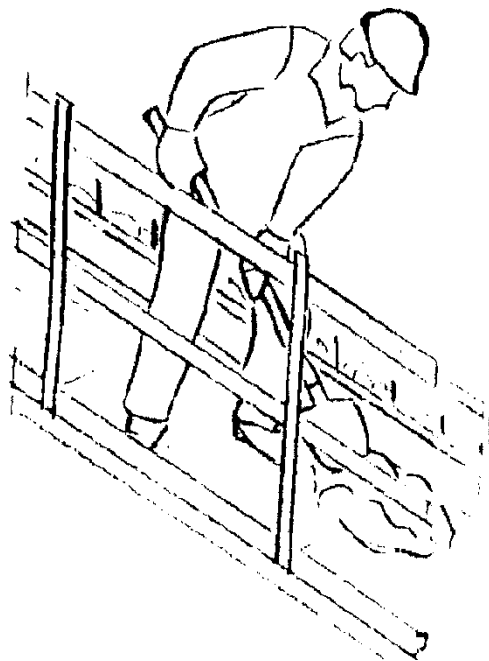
Очистка лопатами просыпавшегося бетона с деревянного настила подмостей и опалубки
